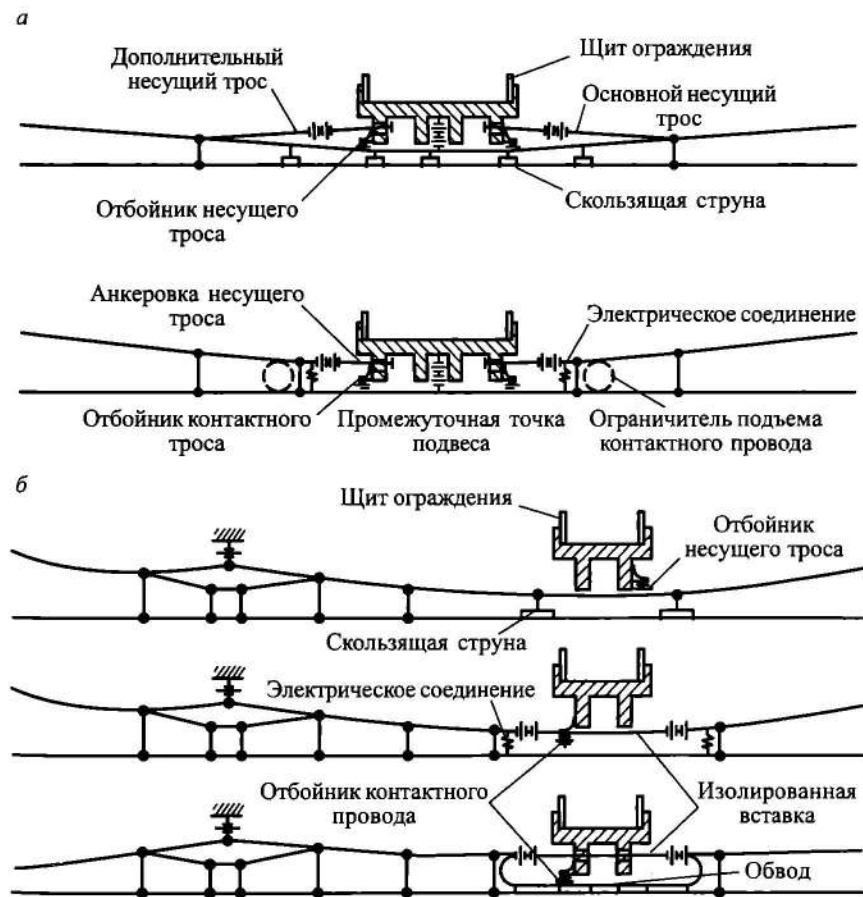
Схемы прохода контактной подвески под путепроводами шириной более 15 м
